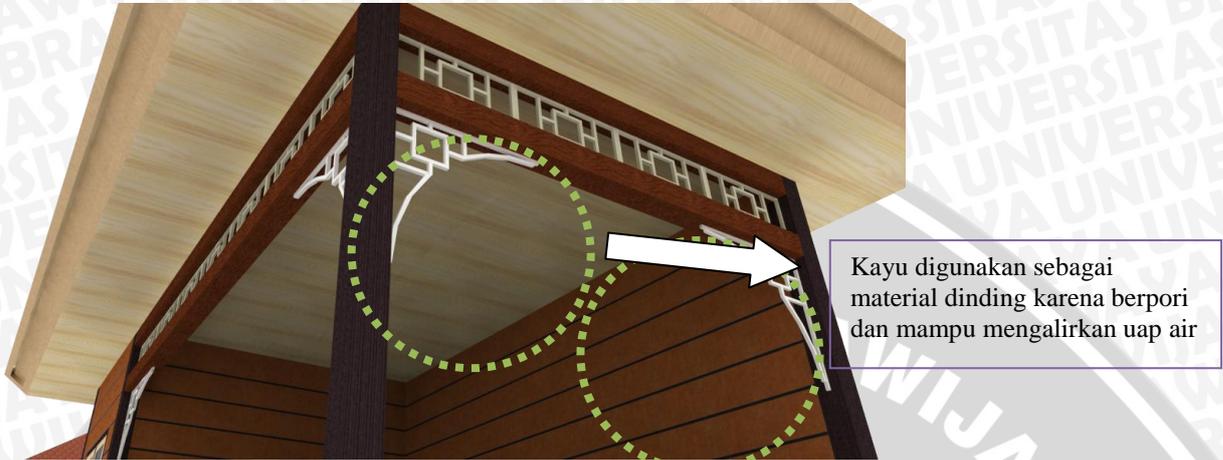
aplikasi ventilasi silang pada bangunan
